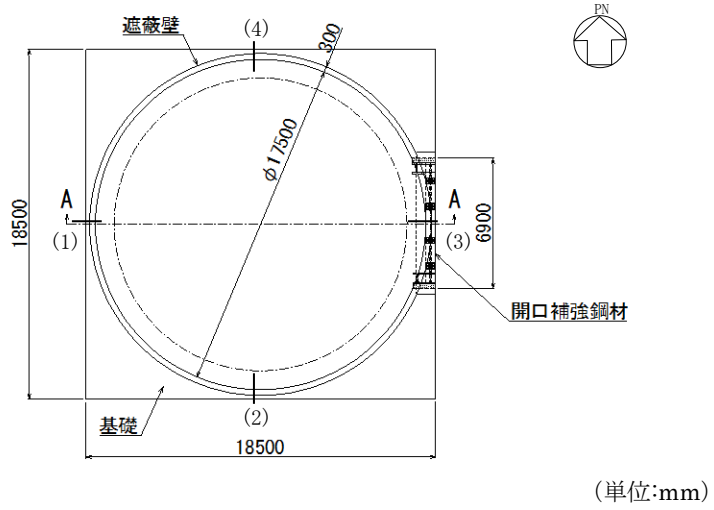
補助復水貯蔵タンク遮蔽壁 平面図
